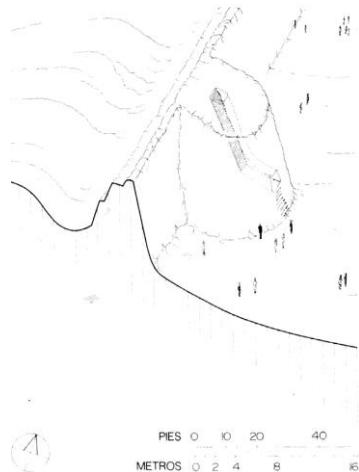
Jericó, muralha e torre (corte e vista em perspetiva)
